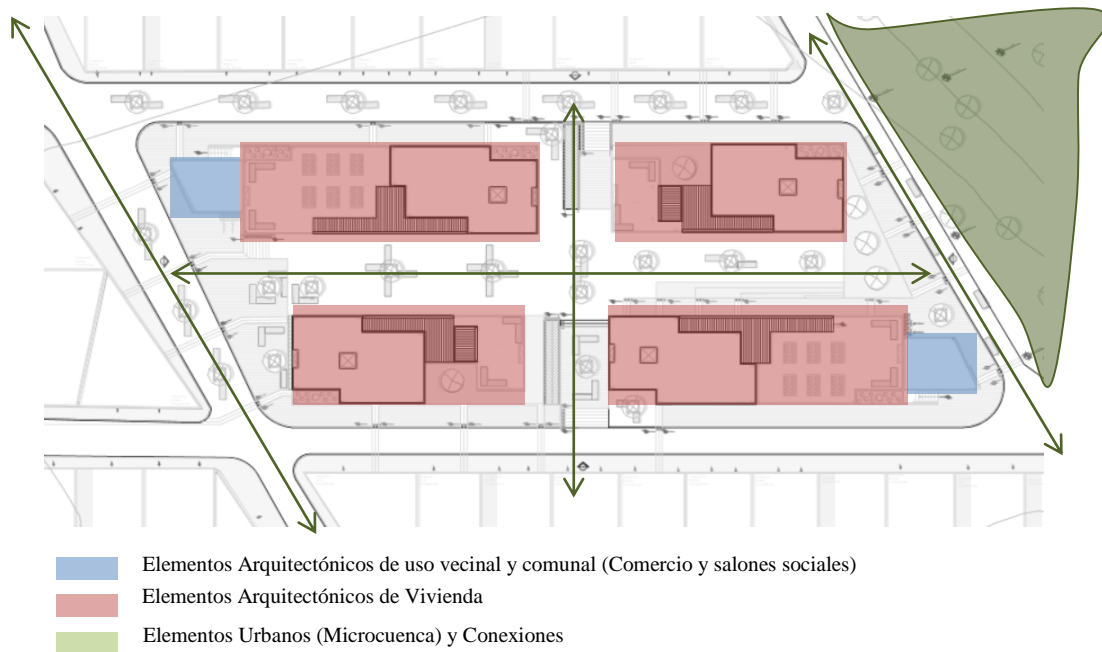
Planta Urbana Manzana 02 + Accesos urbanos y Elementos Arquitectónicos
